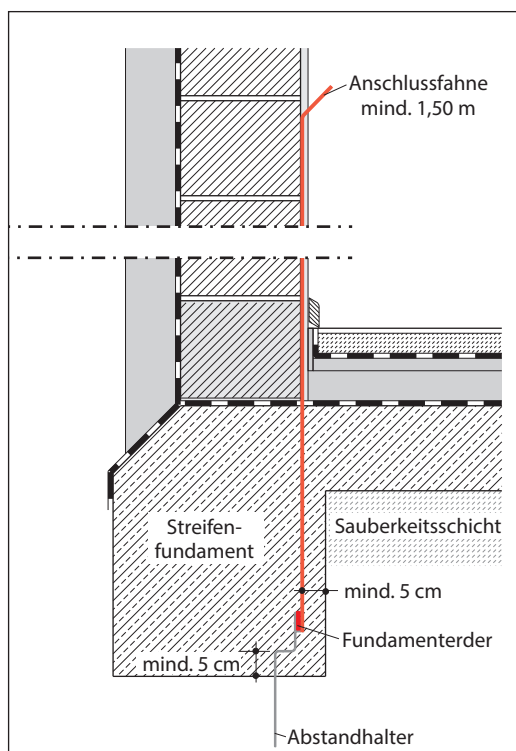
Ausführung eines Fundamenterders im unbewehrten Fundament
